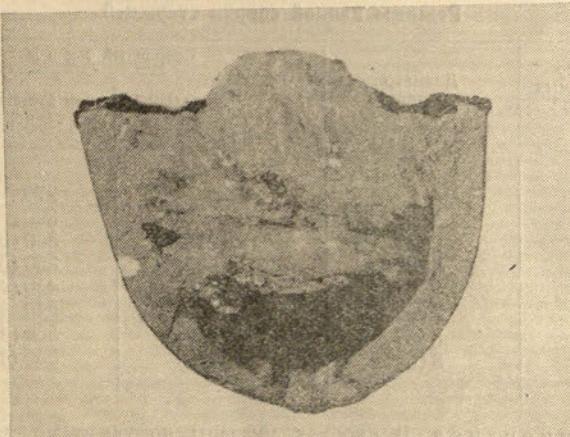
Горизонтальный стык стержней, сваренный ванным способом; разрушение по наплавленному металлу; корень шва зашлакован
